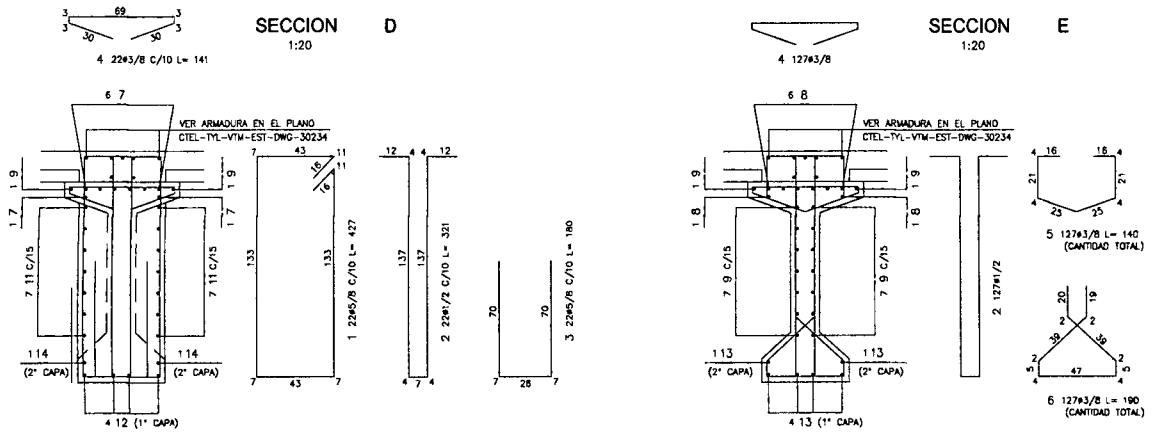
Detalle del acero de refuerzo transversal de la viga.
